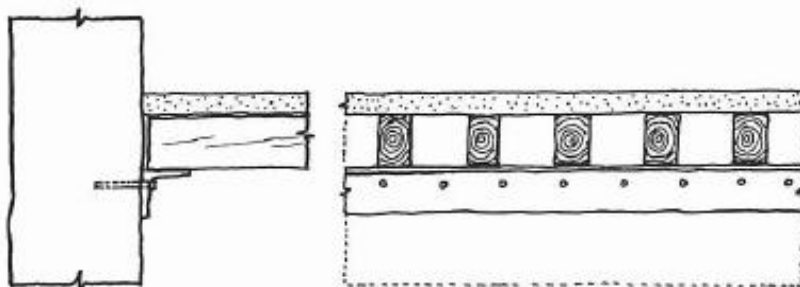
Cantoneira metálica fixada à parede (Arriaga [21])
